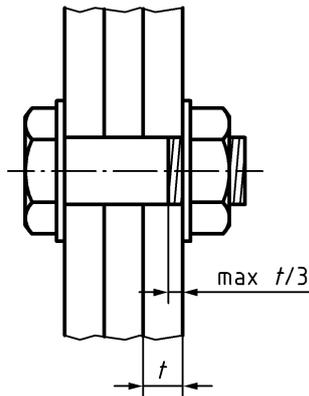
Gewindeanteil des Schraubenschaftes im auf Lochleibung beanspruchten Blech bei Passschrauben
